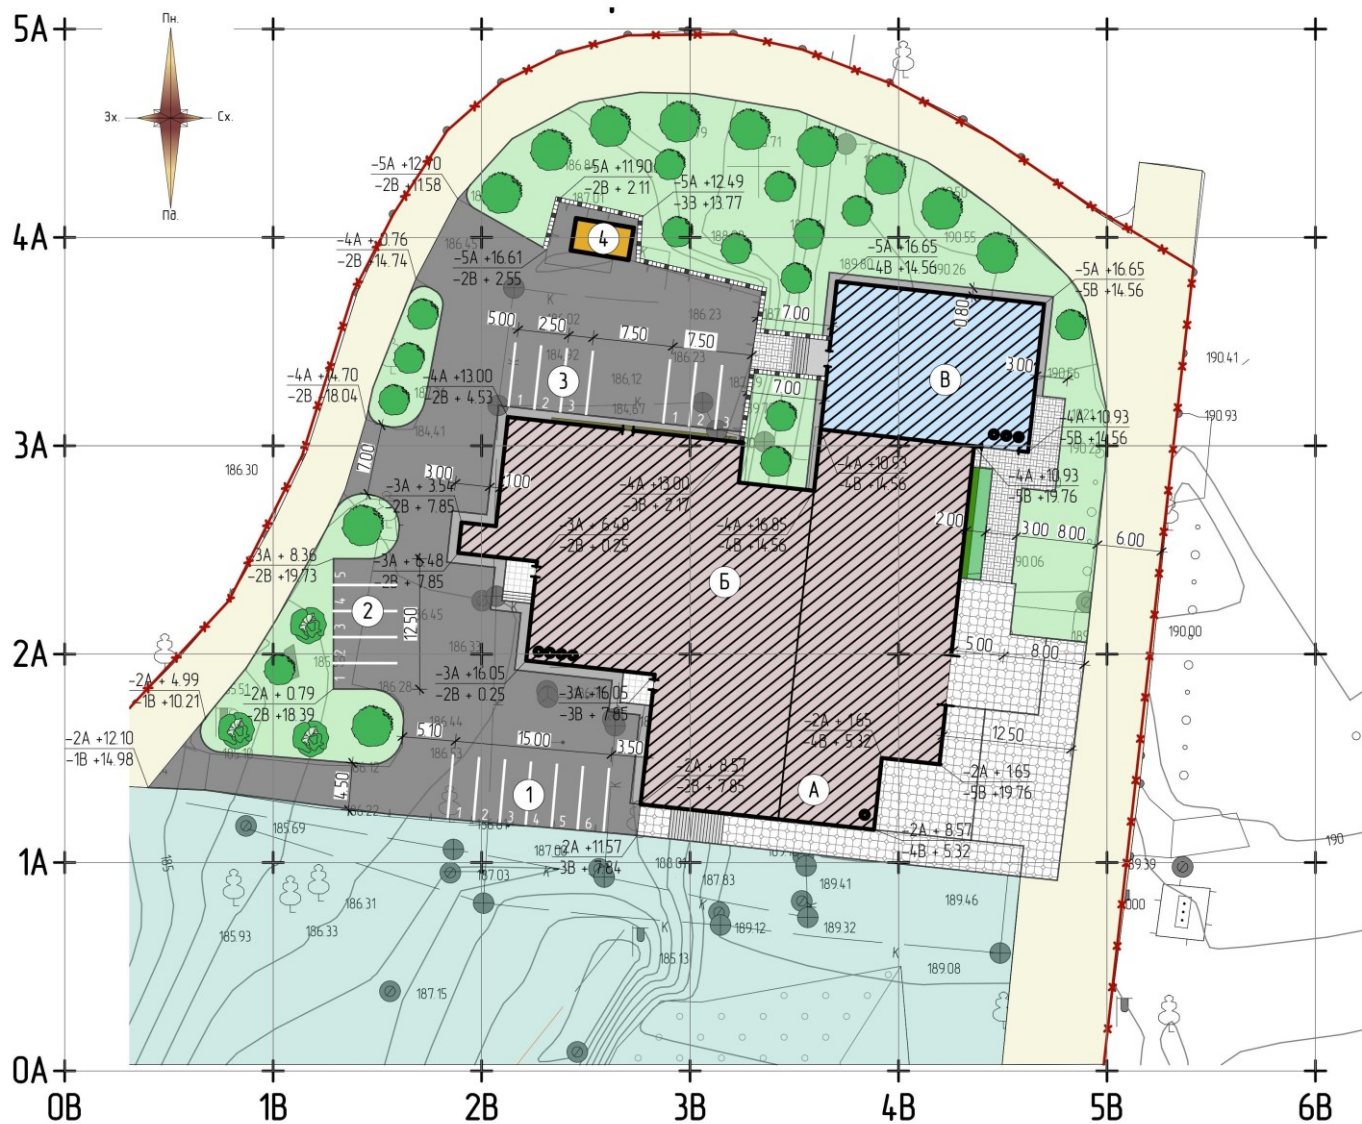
Схема вертикального планування території (фрагмент 3)
